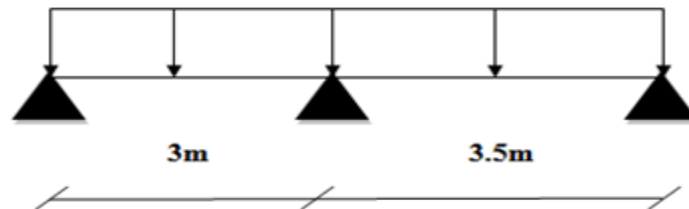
Schéma statique de la poutre reposant sur trois appuis.
